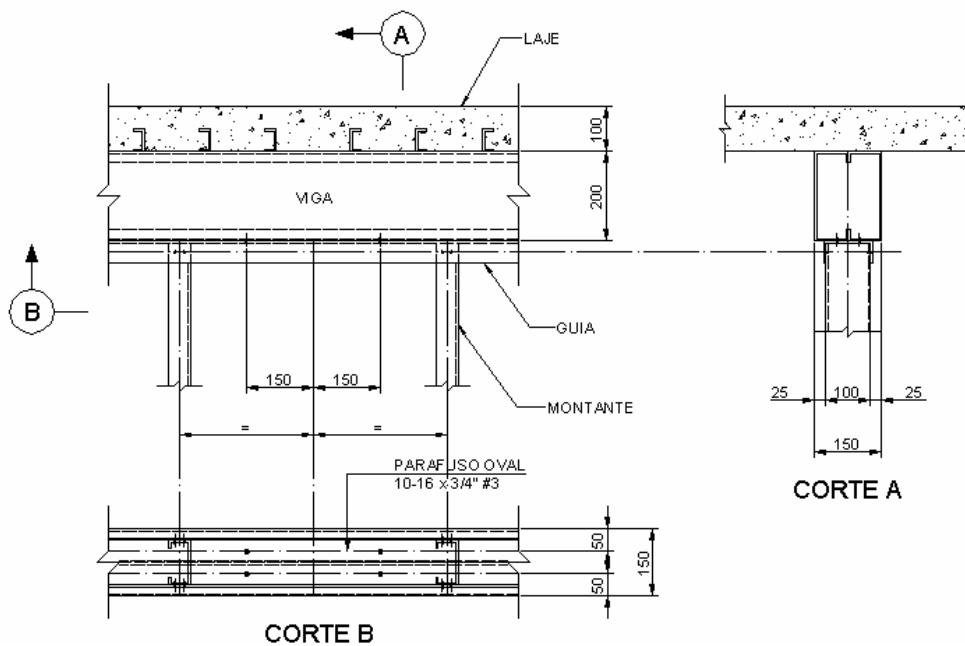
Detalhe construtivo da ligação Guia – Viga [3]
